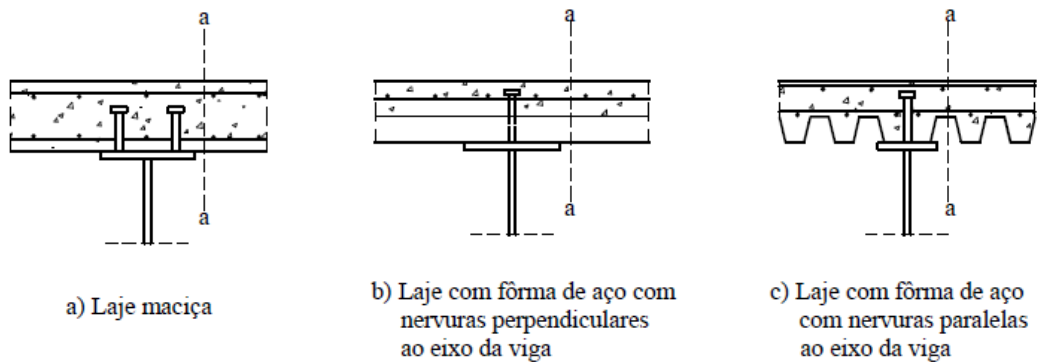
Vigas Mistas de aço e concreto, (NBR 8800, 2008).
